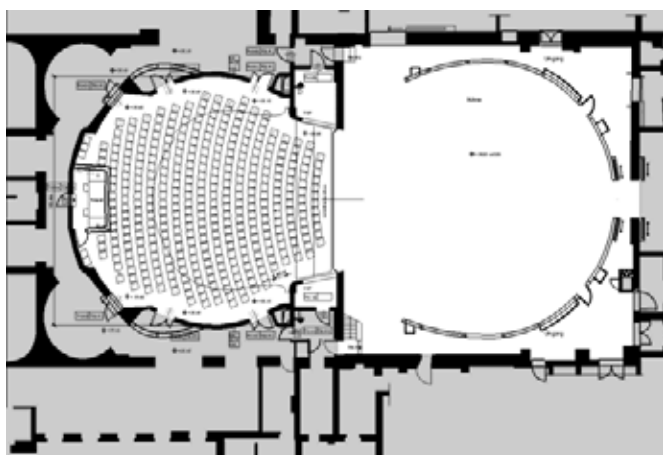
Grundriss Deutsches Theater Berlin
